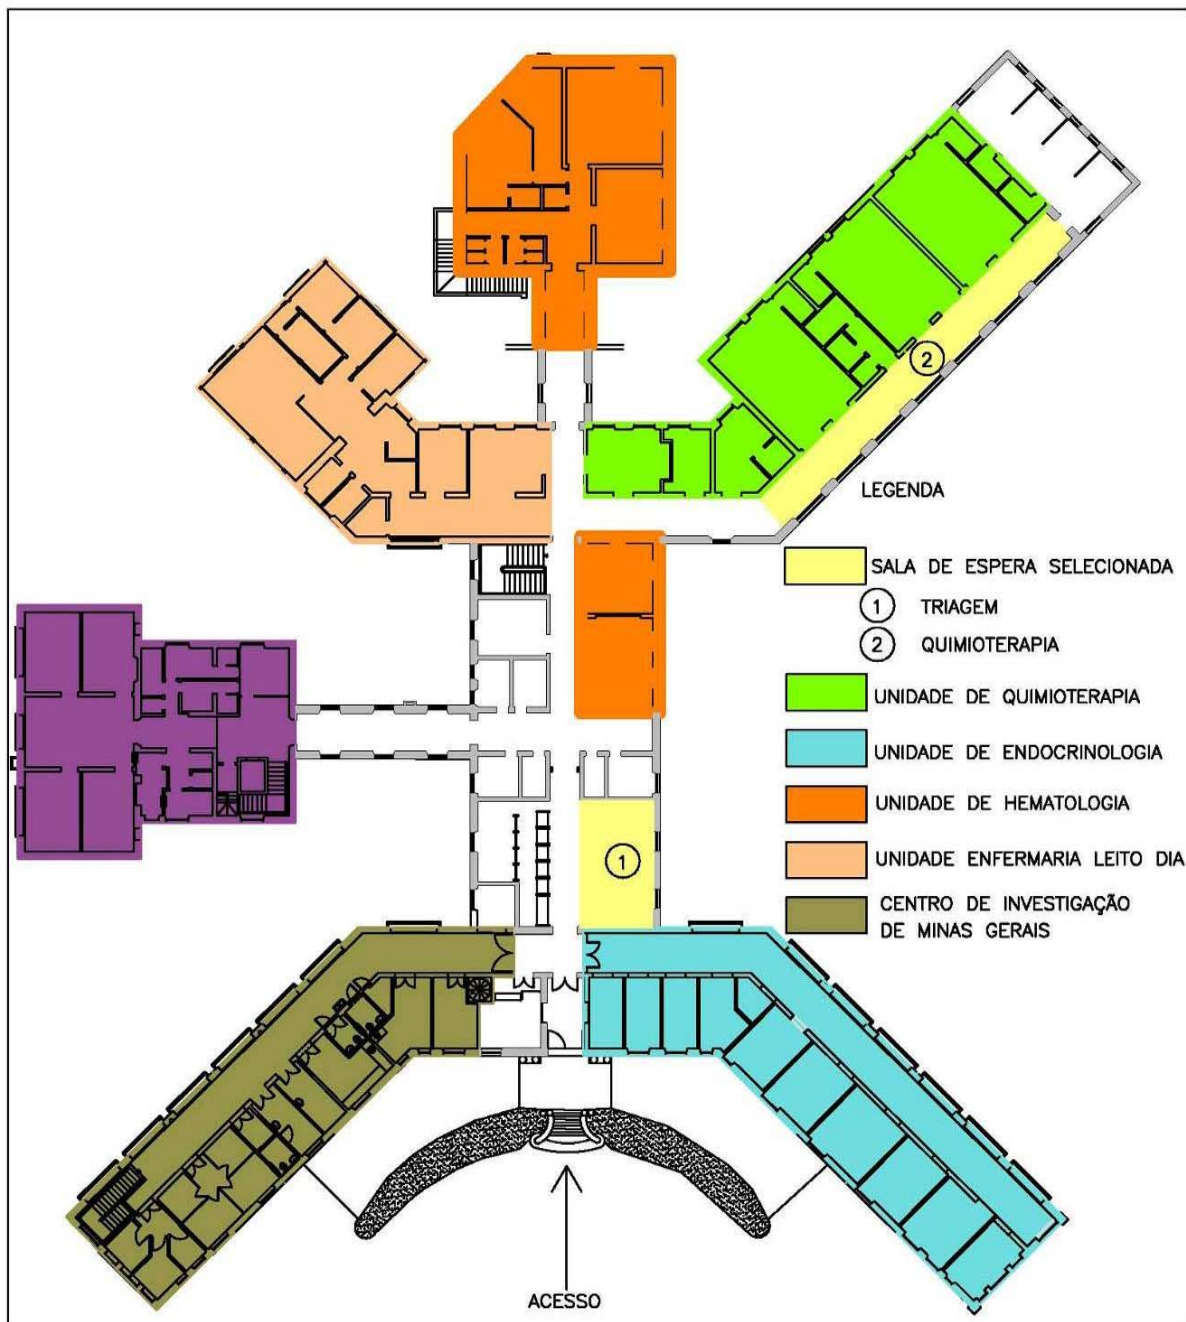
Planta pavimento térreo Hospital Borges da Costa
